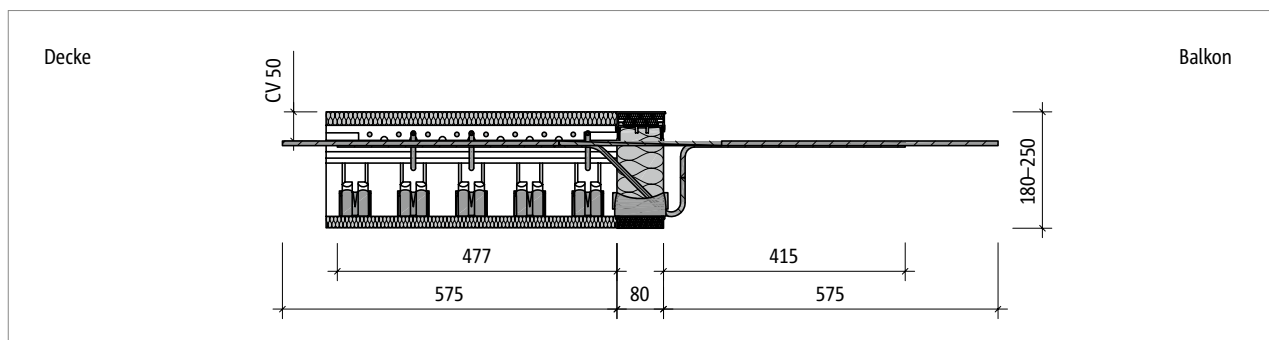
Schöck Isokorb® T Typ C-M1: Produktschnitt
